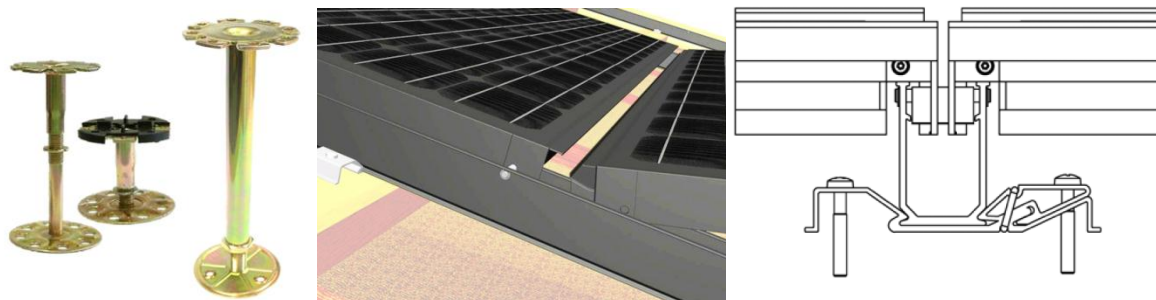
links: Standard Stützen für Doppelböden, Mitte: Detail Querstoss Indachsystem NICER vor dem Einklappen des Modules, rechts: Horizontalschnitt Indachsystem NICER mit Modulen, U-Schiene und Haltefuss mit Holzschrauben (Quelle www.doboplan.de; MegaSol AG).
